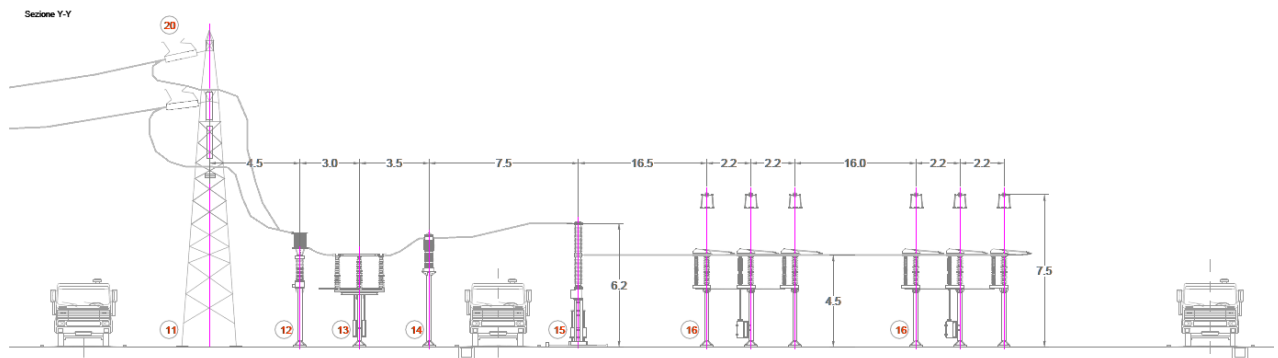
Sezione Y-Y della nuova Stazione Elettrica 150 kV
